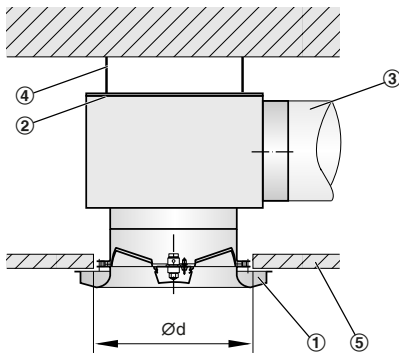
Deckenbündiger Einbau mit quadratischem Anschlusskasten
